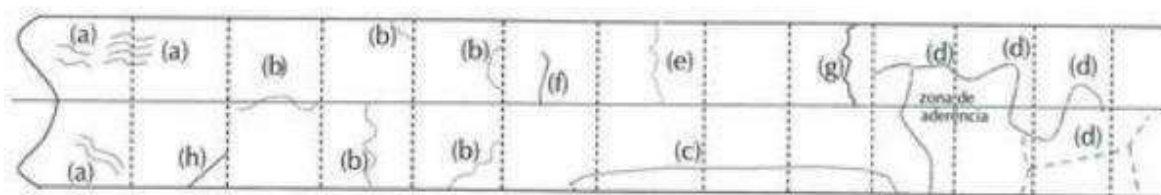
Causas das Trincas em Pavimentos de Betão (Fonte: Silva, 2008)
